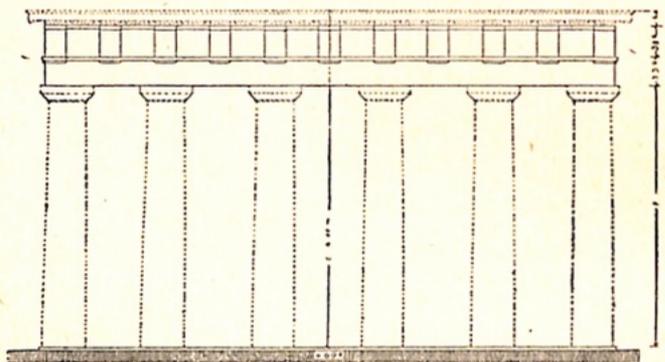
Théâtre de Dionysos : façade à colonnes de l'une des parascénies (reconstruction).
